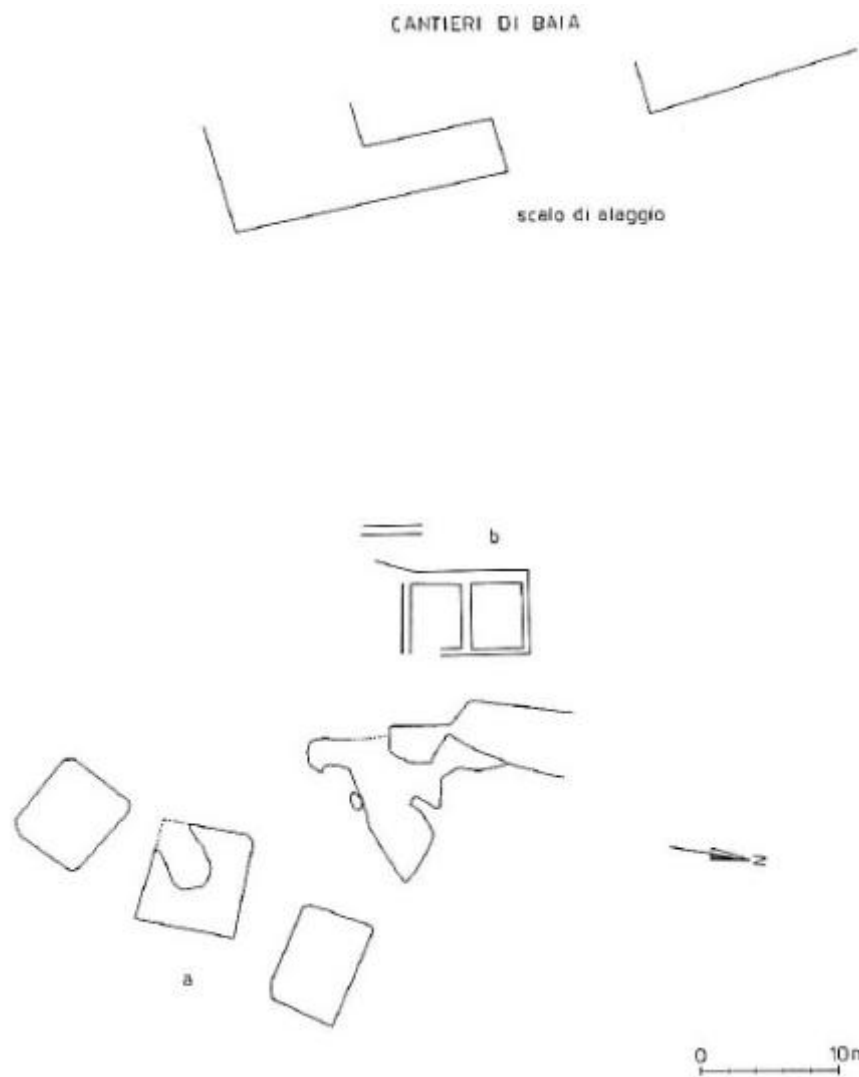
Planimetría de las estructuras sumergidas junto a los astilleros modernos entre los que figuran tres *pilae*. (DI FRAIA, G. 1993, p. 39).
